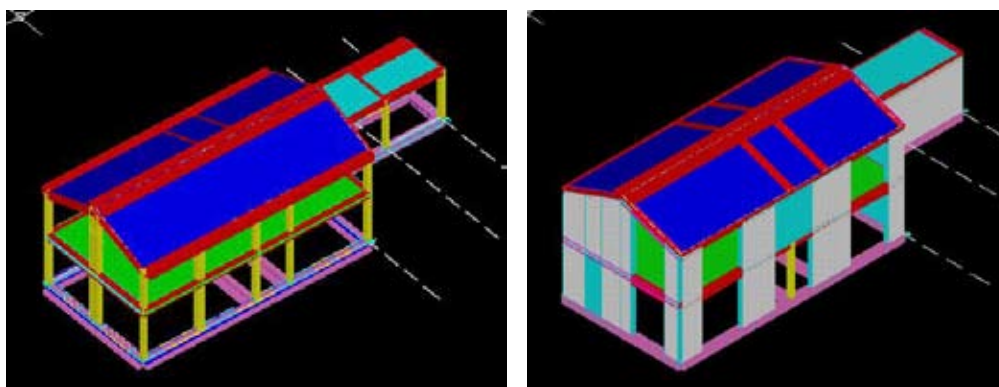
Modello strutturale dell'ipotesi "A" per soluzione intelaiata in c.a. (a sinistra) e dell'ipotesi "B" con muratura portante (a destra).
